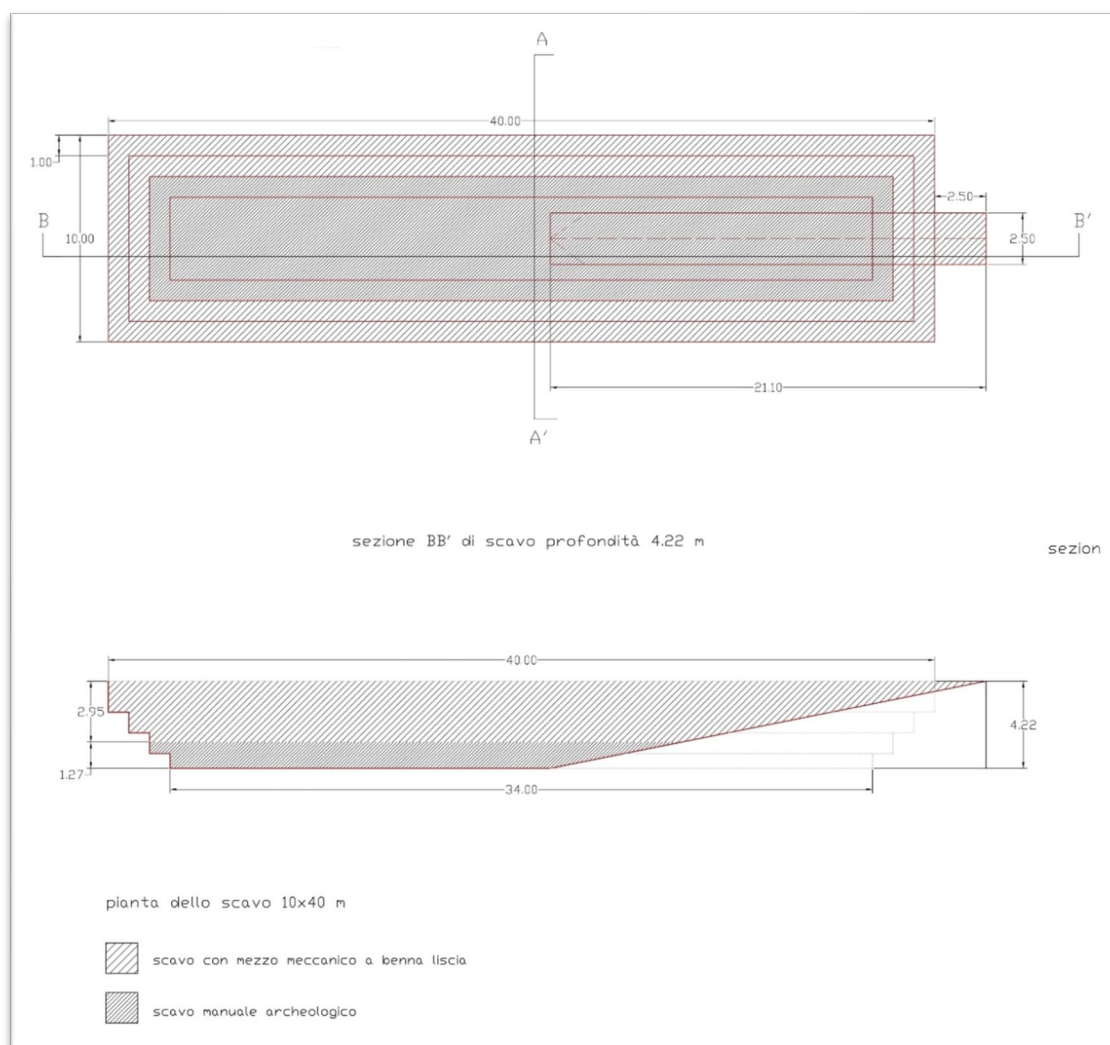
Pianta e sezione longitudinale tipo di trincea di scavo della Trincea 40 x 10 m
